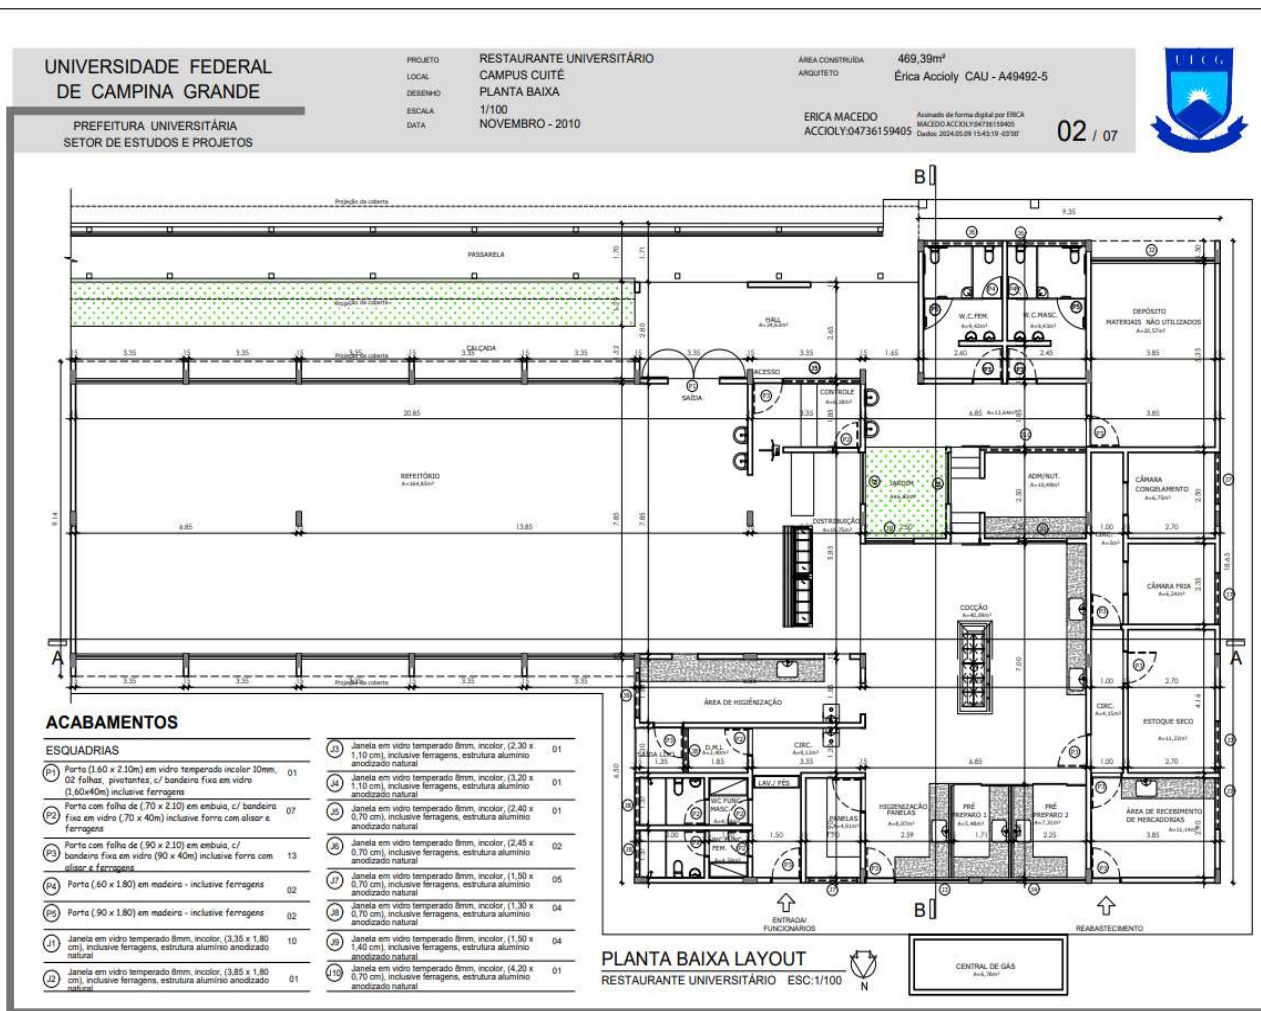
Planta Baixa da Edificação RU do CES/UFCG. Fonte: PU/UFCG
